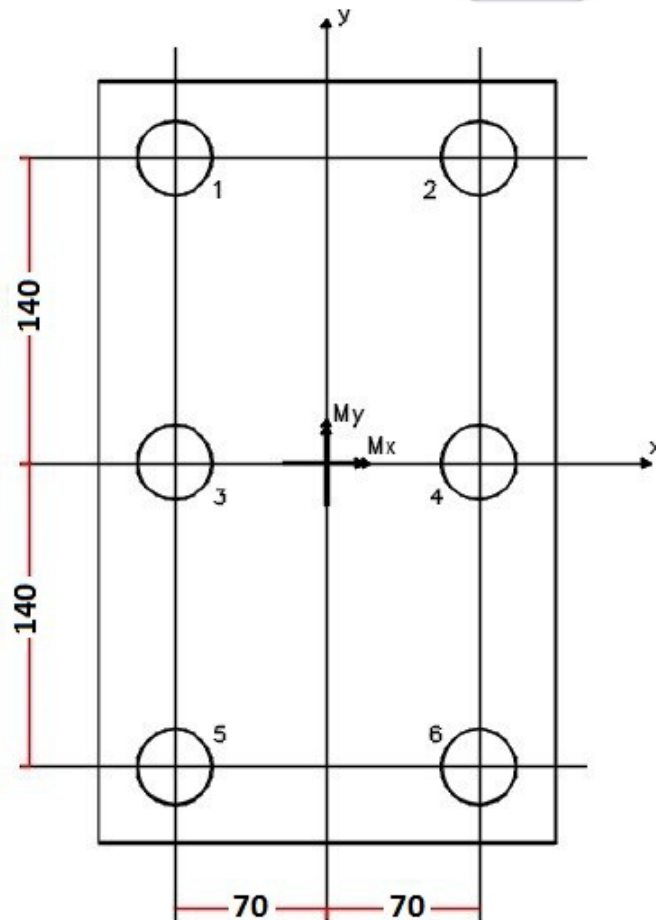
Planta baixa de bloco sobre estaca (medidas em cm)
